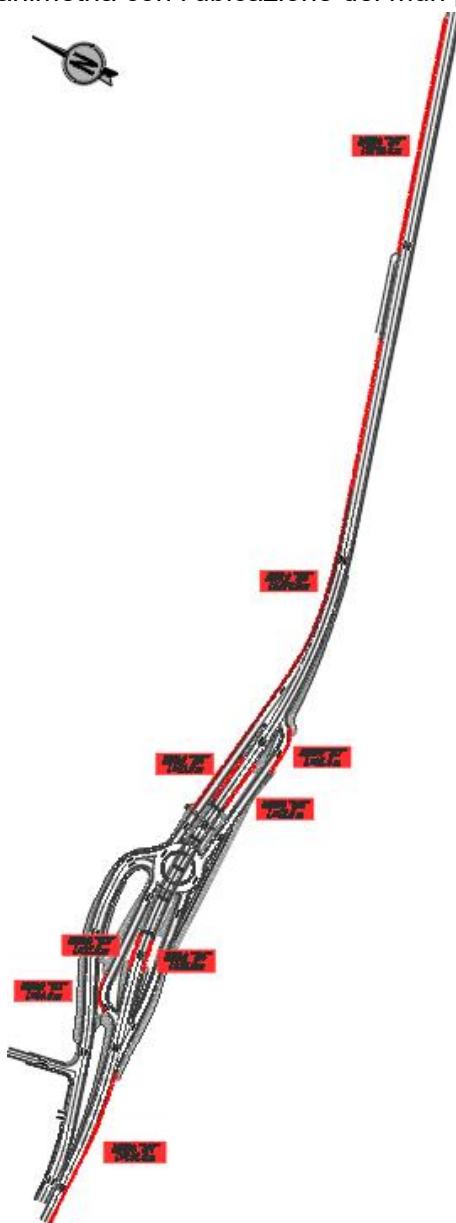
Planimetria con indicazione posizione dei muri di sostegno
